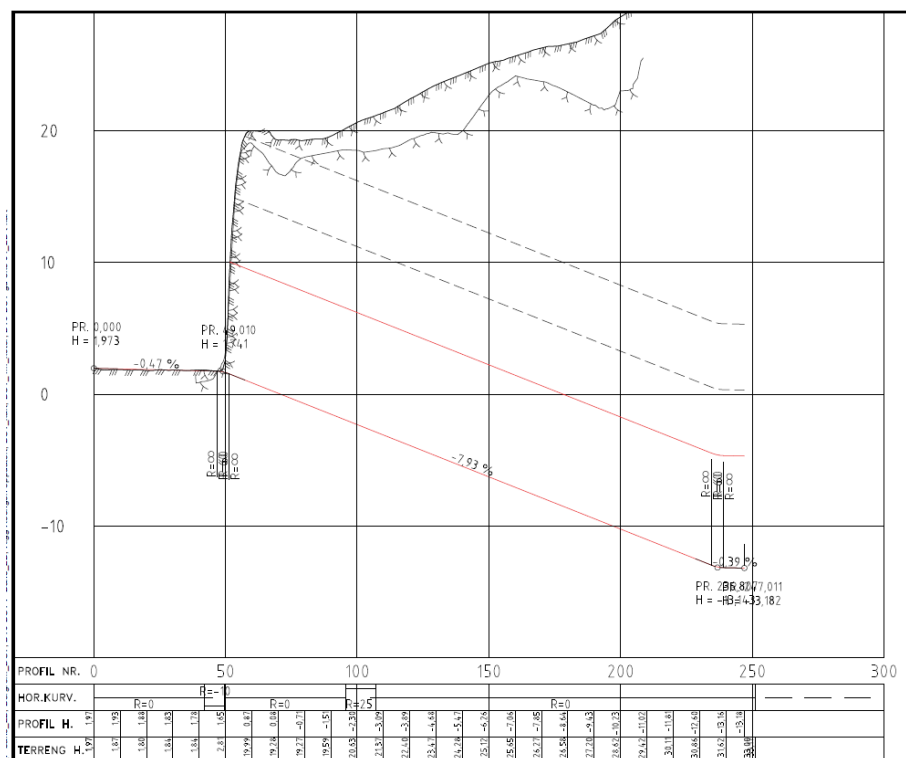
Lengdeprofil anleggstunnel i alternativ T1.
